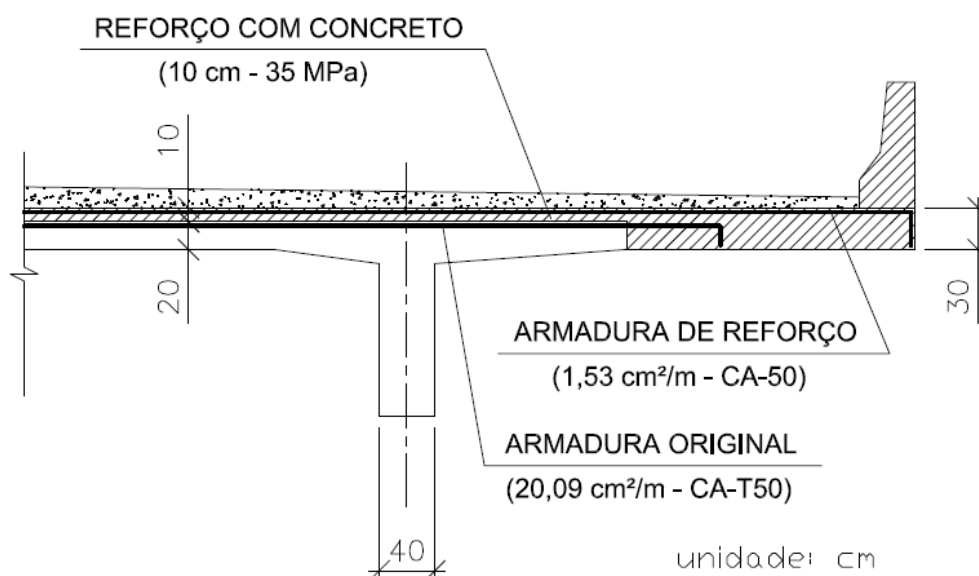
Reforço da laje em balanço por encamisamento com concreto armado.
